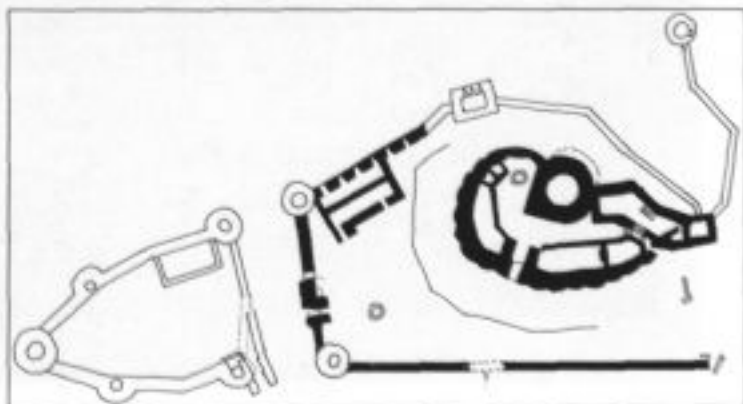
plan du site actuel avec les phases de construction hypothétique.
